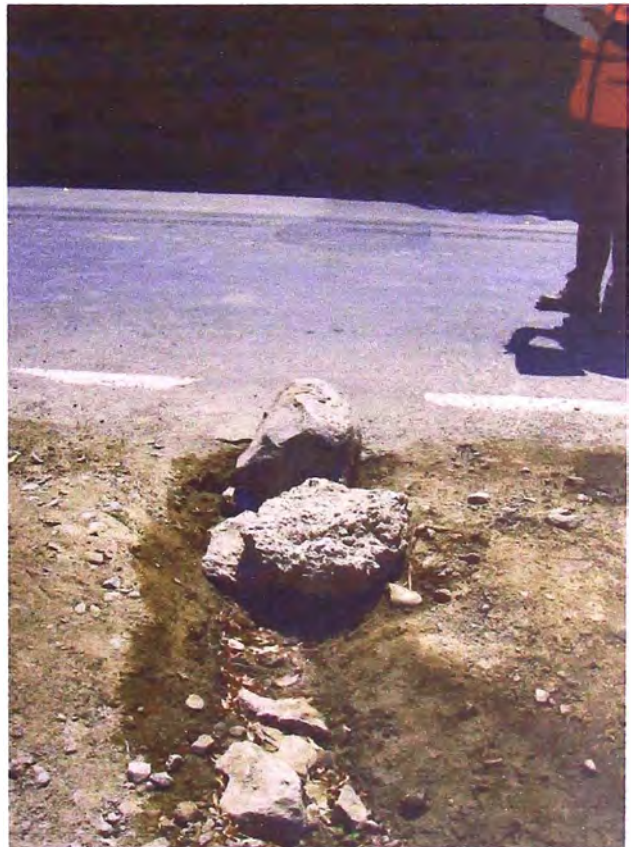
Km 67+620 es necesario la construcción de un emboquillado, además de 01 alcantarilla de TMC de D=46”.
